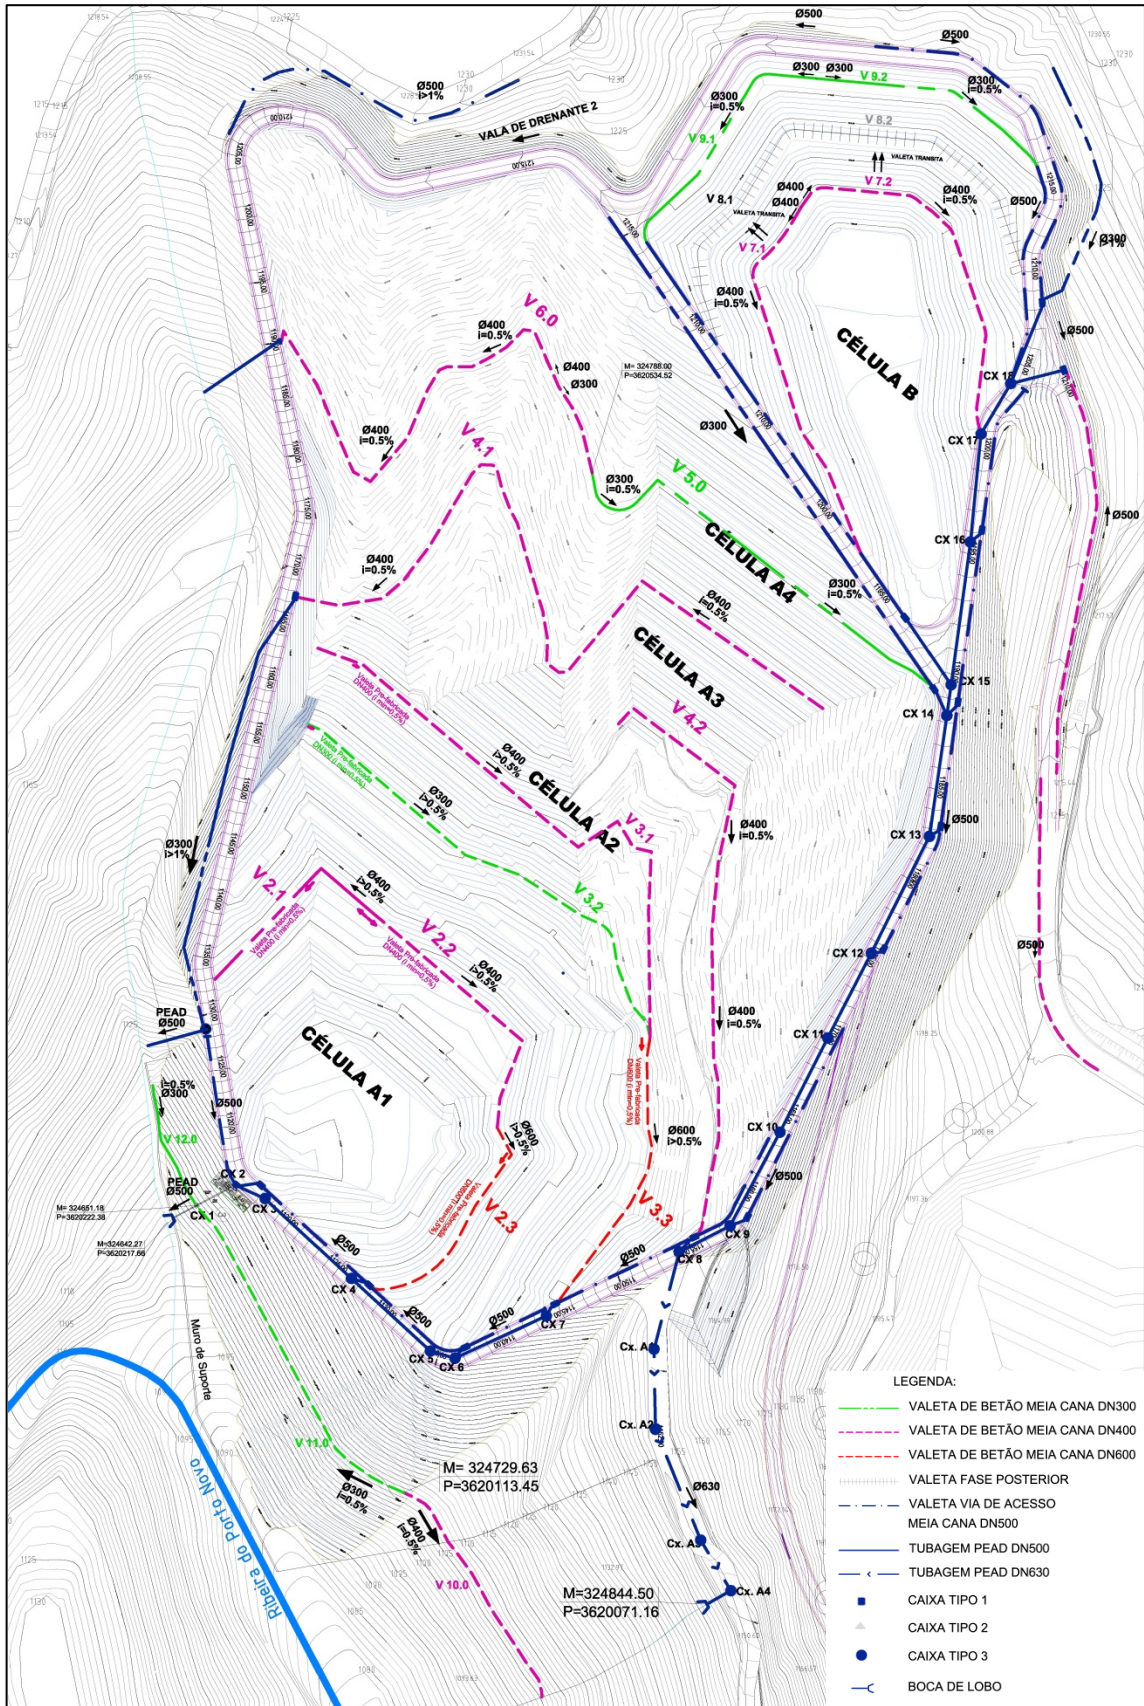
PLANTA DE VALAS DRENAGEM E CONDUTAS DE DRENAGEM PLUVIAIS, (ADAPTADO VALOR AMBIENTE, (2013)).
